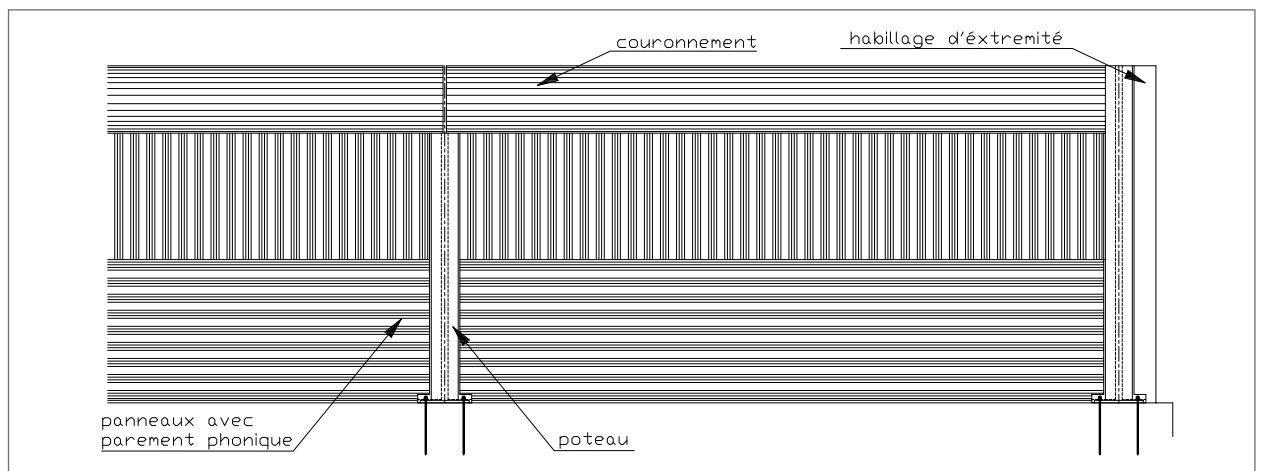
Élévation type d'un panneau en béton armé reposant sur une semelle filante et maintenu entre des profilés H
